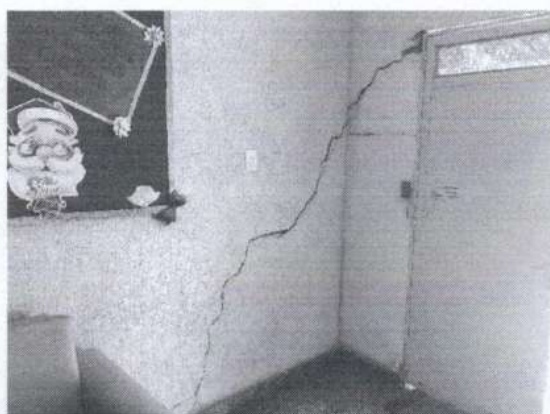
Trinca a 45° localizada no hall – trechos de alvenarias desconectadas
